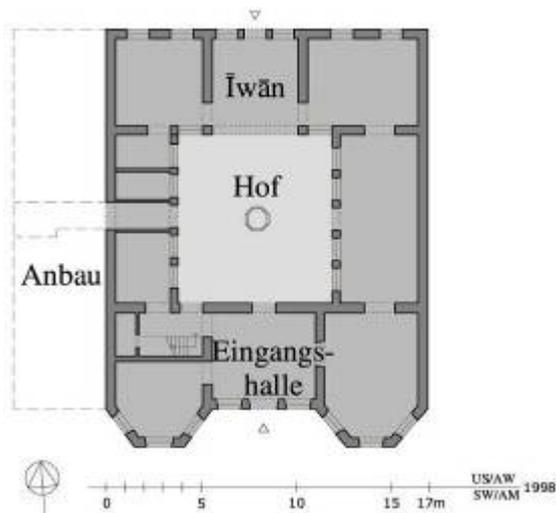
Haus Kat.-Nr. XXIV/4-811, Grundriss EG
